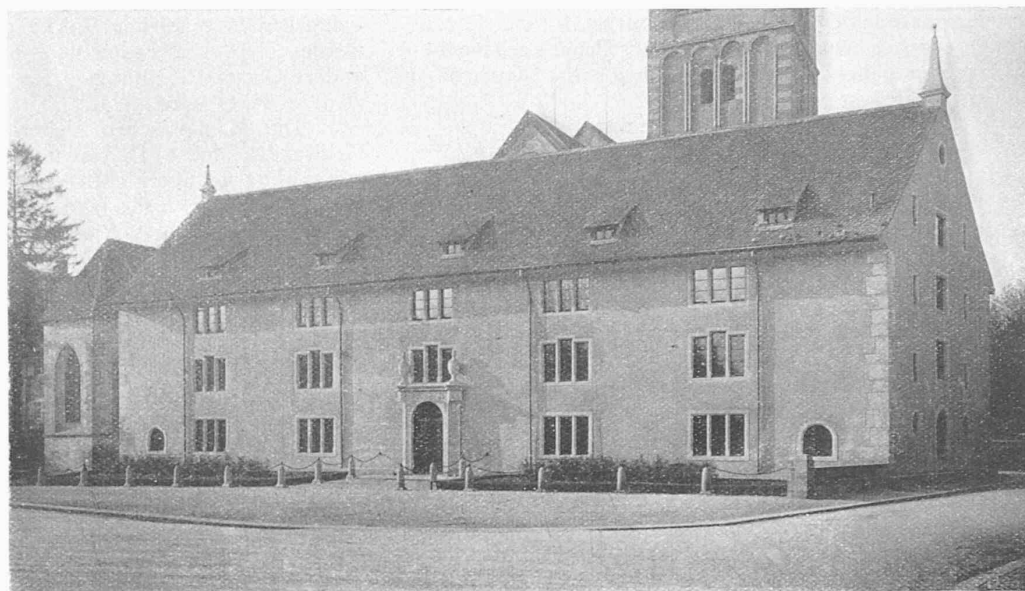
Ostfront, Abb. 24 Schnitt und Abb. 25 Erdgeschoss-Grundriss 1:400 der Stadtbibliothek Schaffhausen. Architekten Schäfer & Risch, Zürich-Chur; örtliche Bauleitung Arch. Otto Vogler, Schaffhausen.
